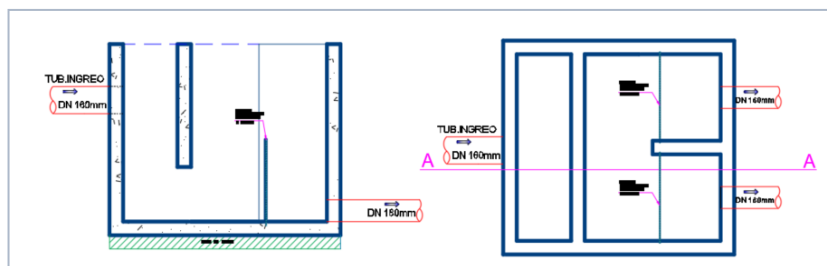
DETALLE DE CAMARA DISTRIBUIDOR DE CAUDALES
